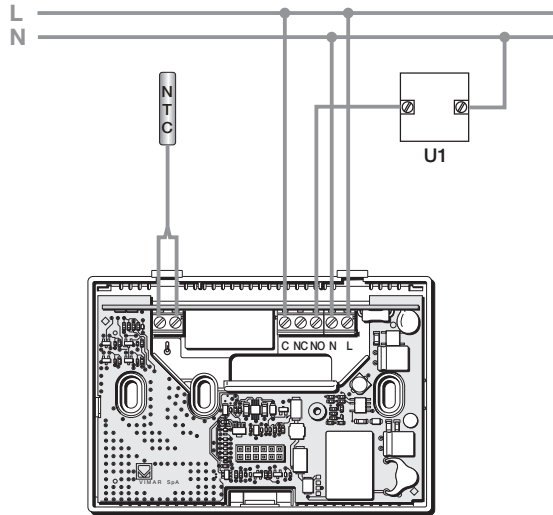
Collegamenti con pompe di circolazione, bruciatori ed elettrovalvole
